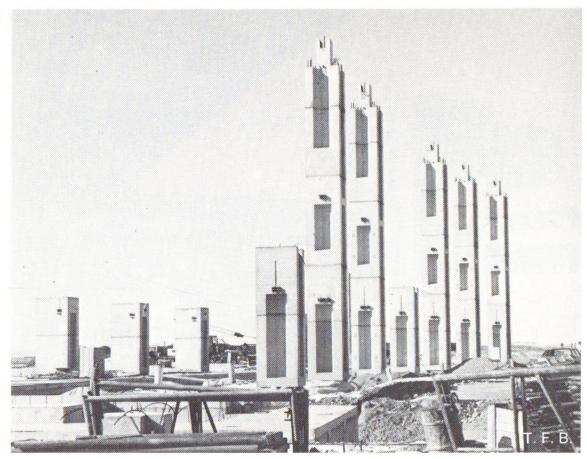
Groupe de piliers en montage. A gauche, une file de piliers au profil en Y pour la partie médiane de la halle, à droite, des piliers en X pour la partie latérale de la halle et la route.
